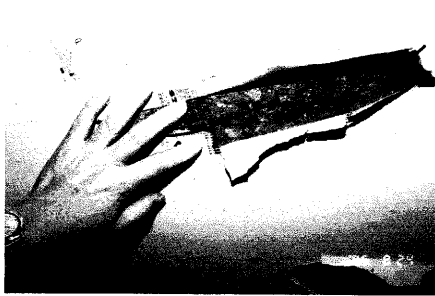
橋台下部のひび割れと塗料の剥離
